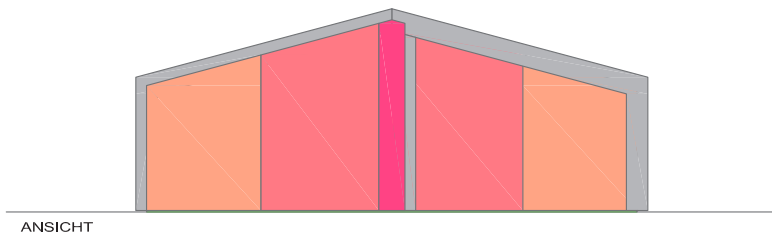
| Systeminneneck Grundriss und Ansichten (mit Firststellung)
